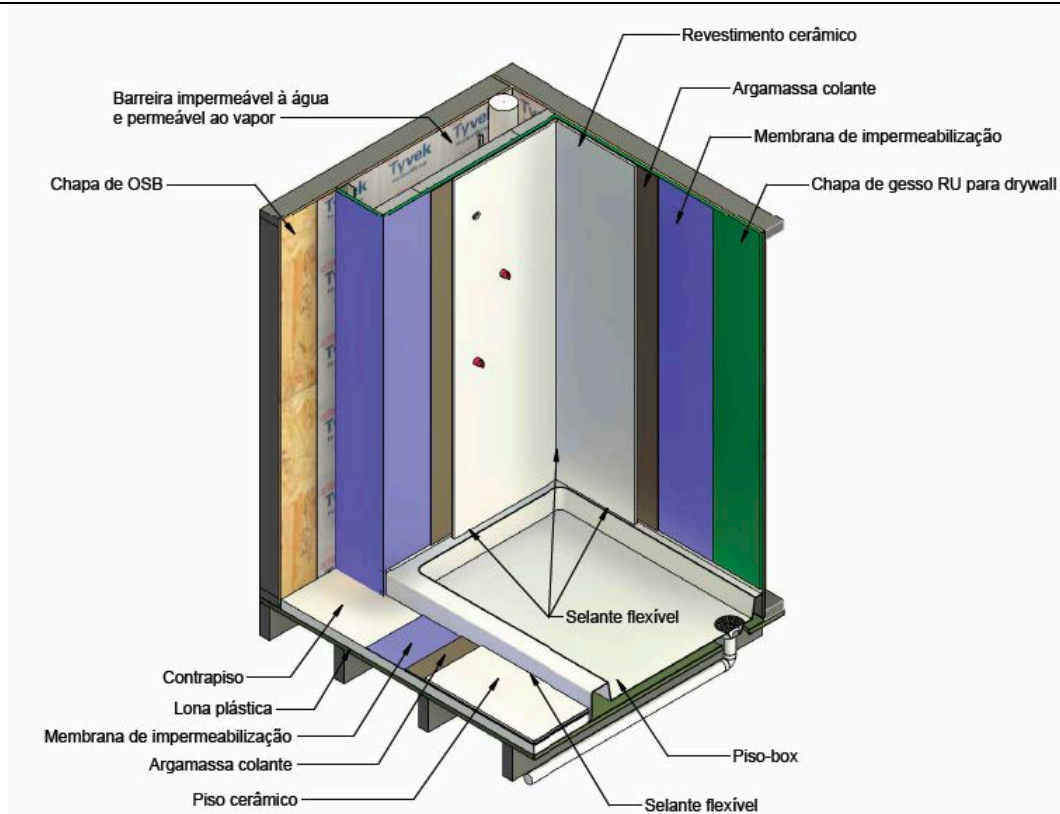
Ilustração esquemática dos elementos que compõem as paredes e sistema de piso que conformam o box em banheiro do pavimento superior com piso box em PRFV.
